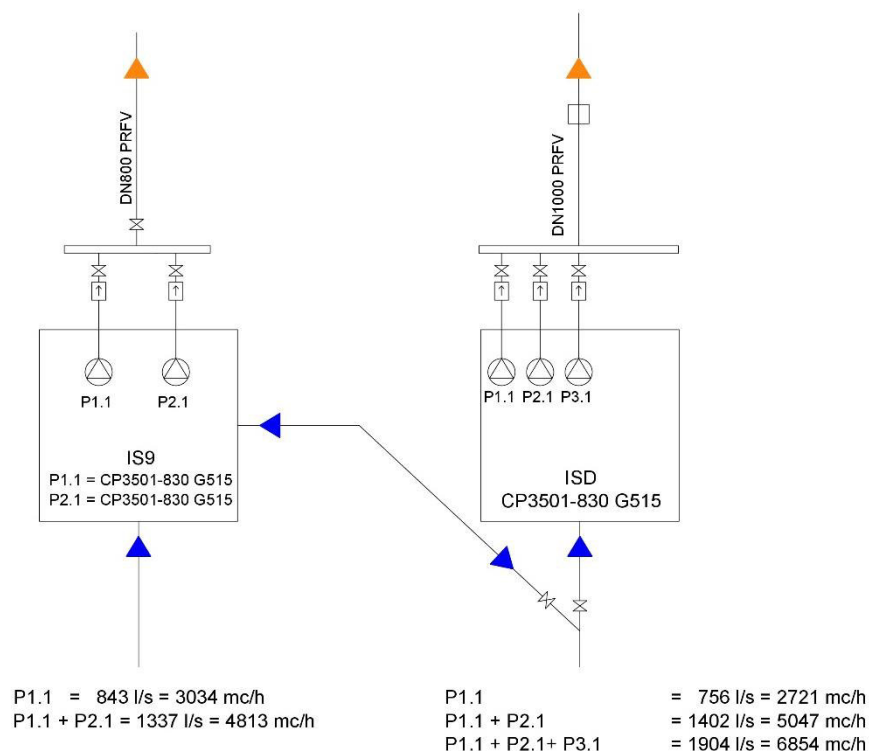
Stato di progetto schema Idrico stazioni IS9+ISD
